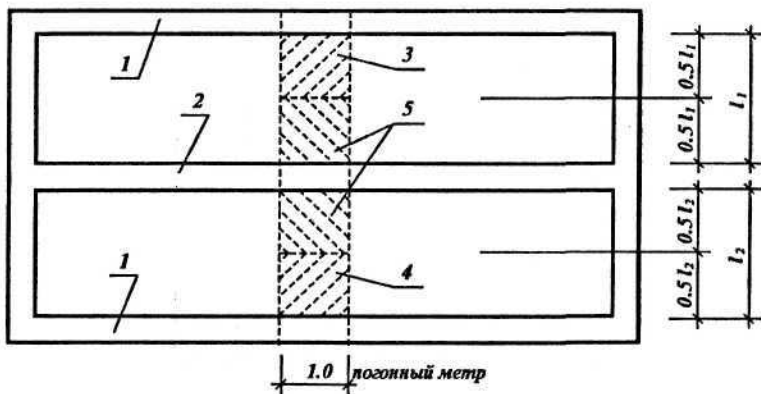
Схема сбора нагрузок с перекрытия (покрытия). План:
